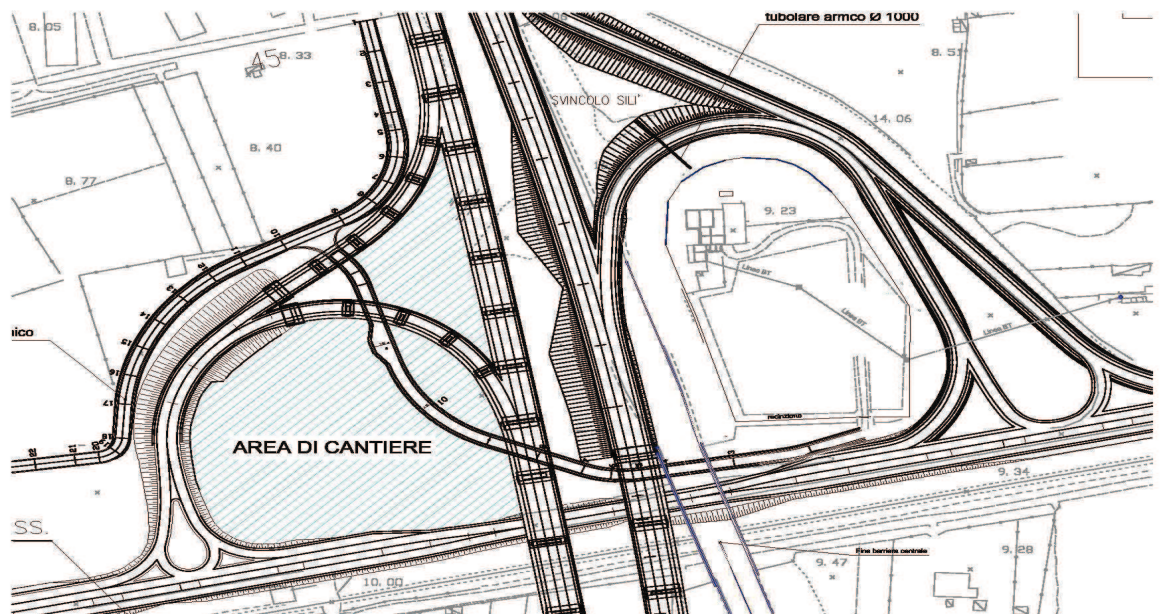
Planimetria area di cantiere nei pressi dello svincolo di Sili
